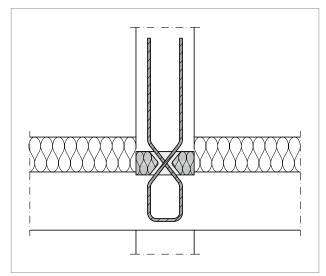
Schöck Sconnex® type W-N-VH : coupe C-C, mur intérieur; isolation sur la dalle
